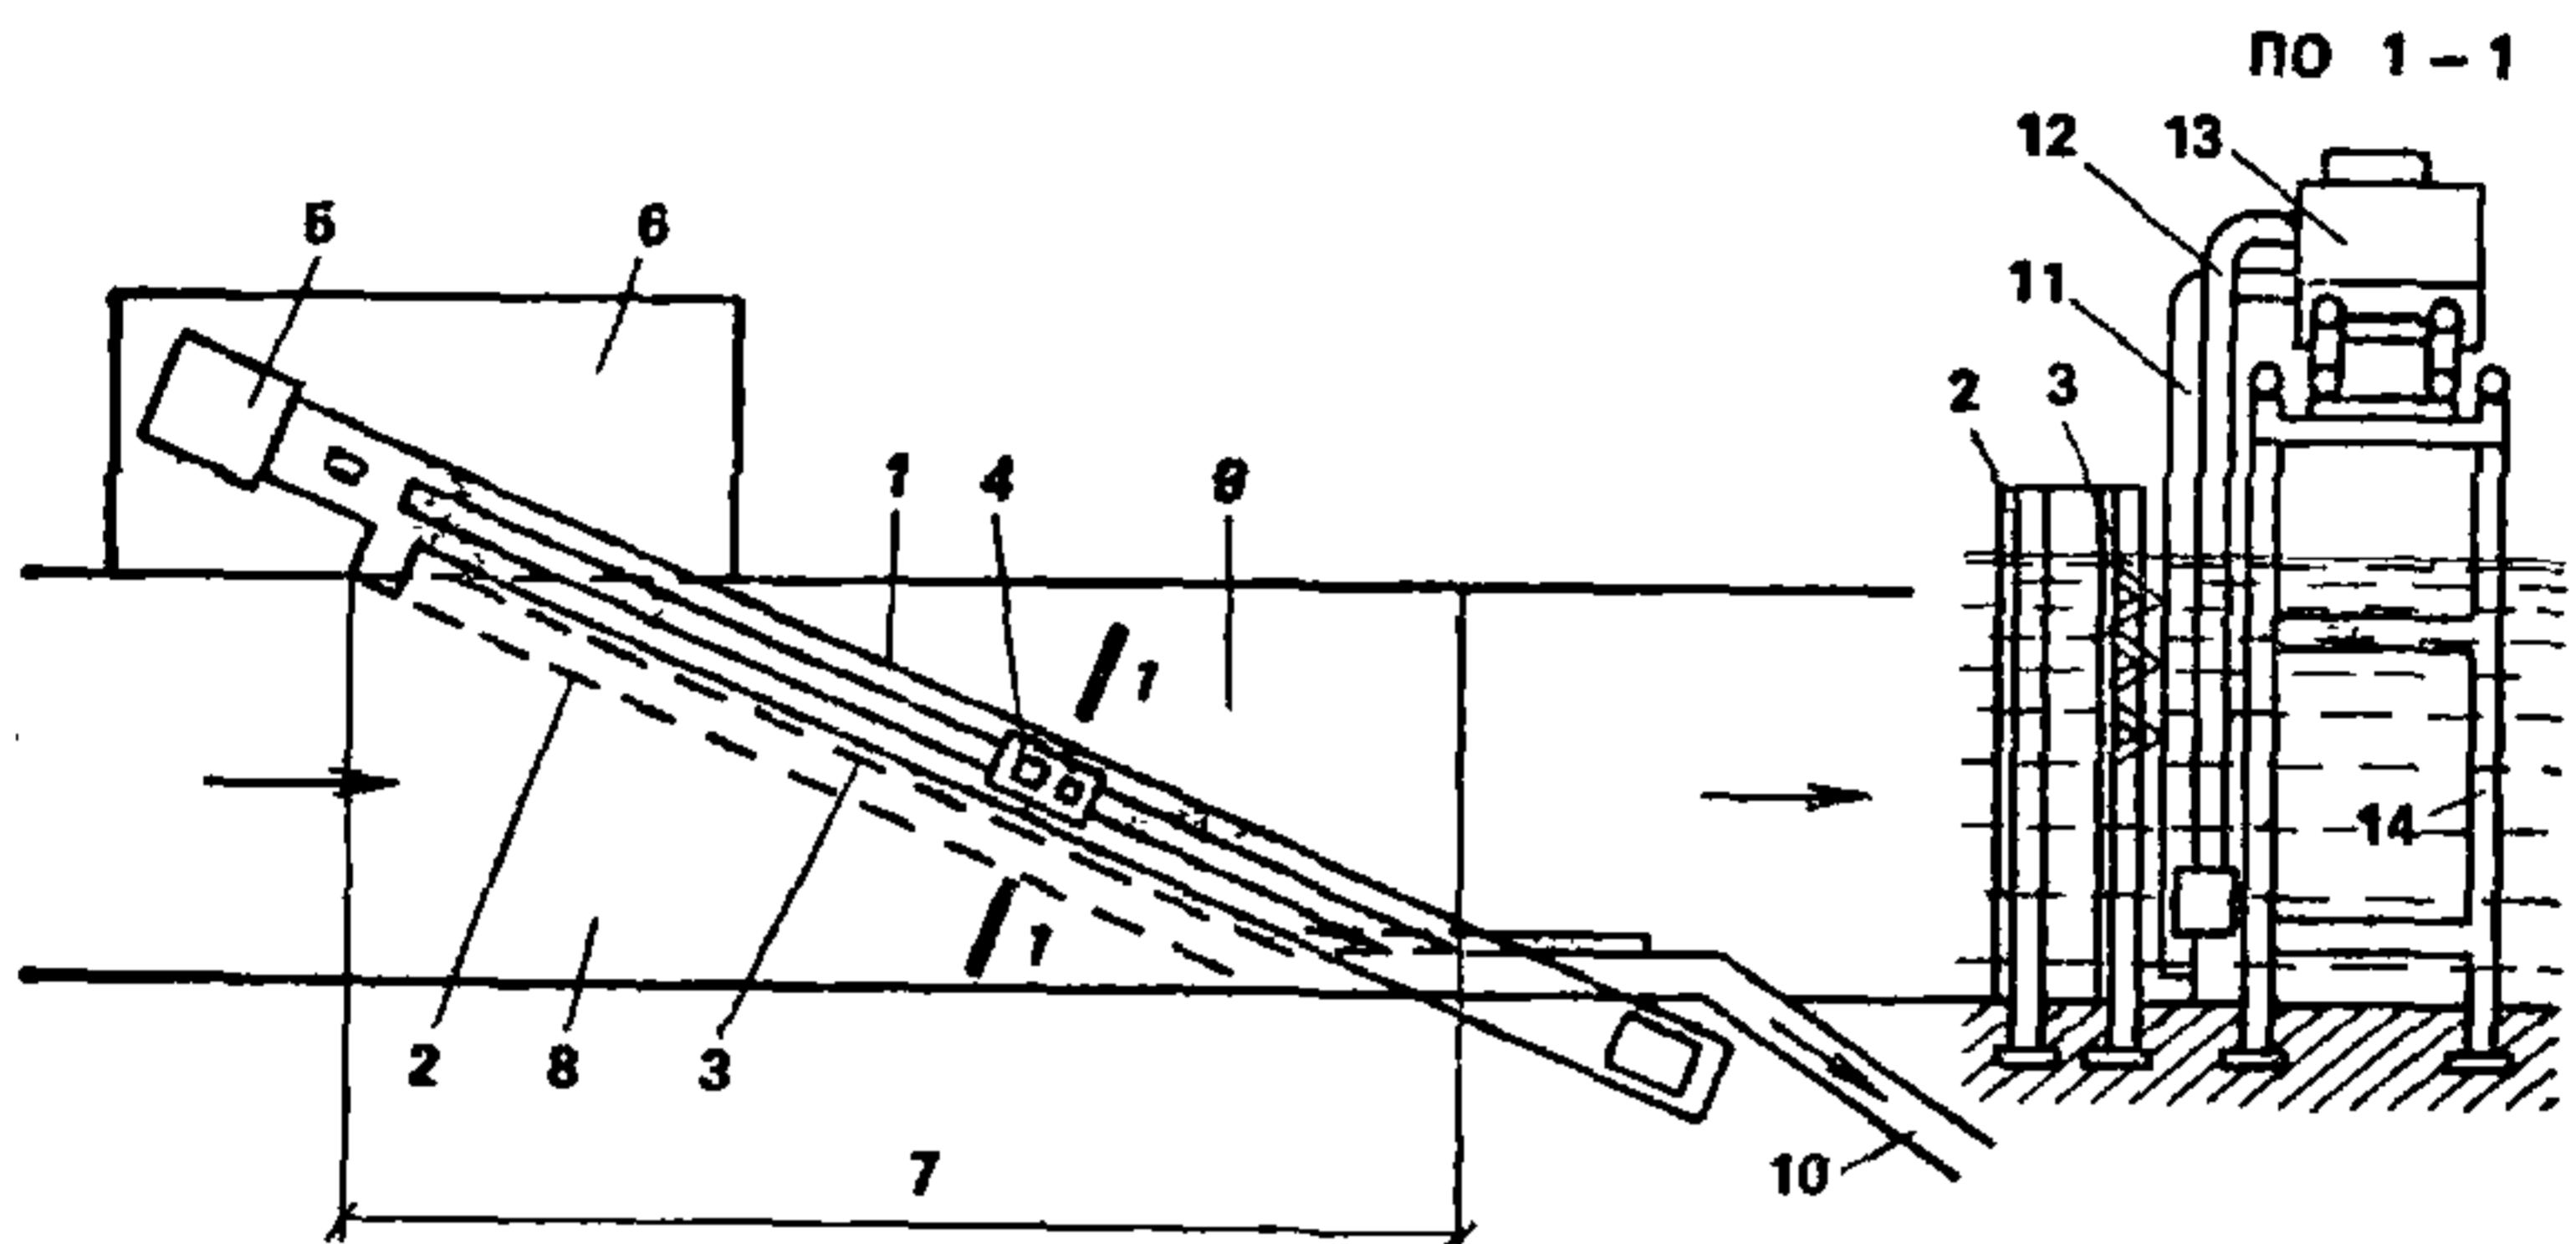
Схема расположения элементов конструкции рыбозащитного устройства типа плоской сетки с рыбоотводом
